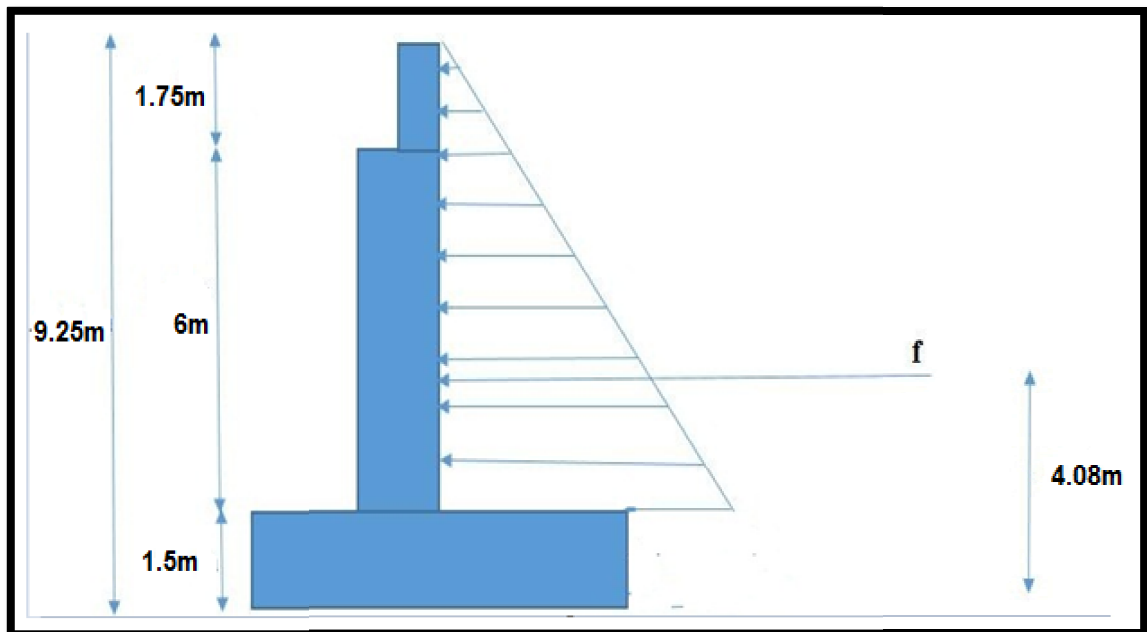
Poussé des terres sur (le mur frontal + mure garde grève et la semelle).
